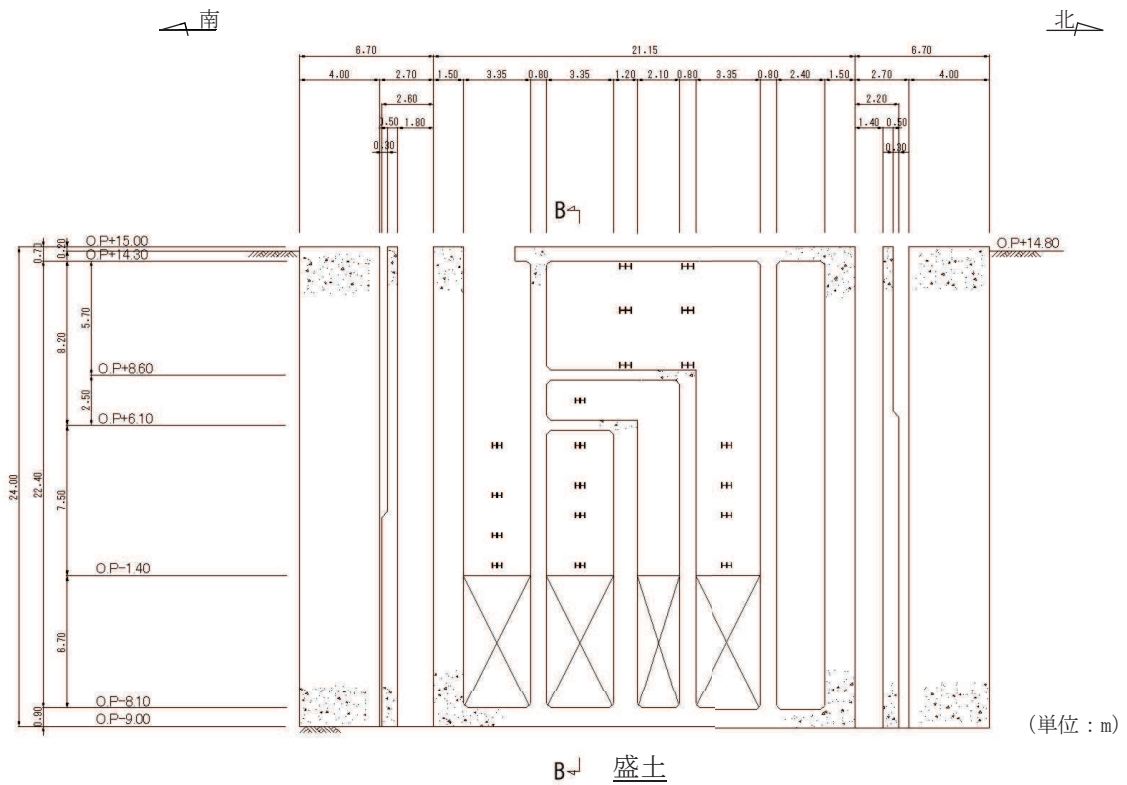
原子炉機器冷却海水配管ダクト（鉛直部）平面図
